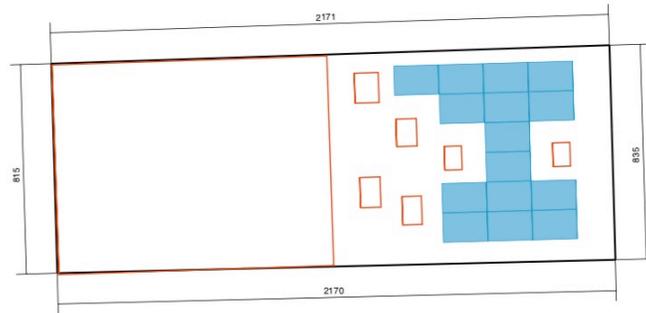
1. Gangstrasse 11, Belegungsplan der südlichen Dachfläche
